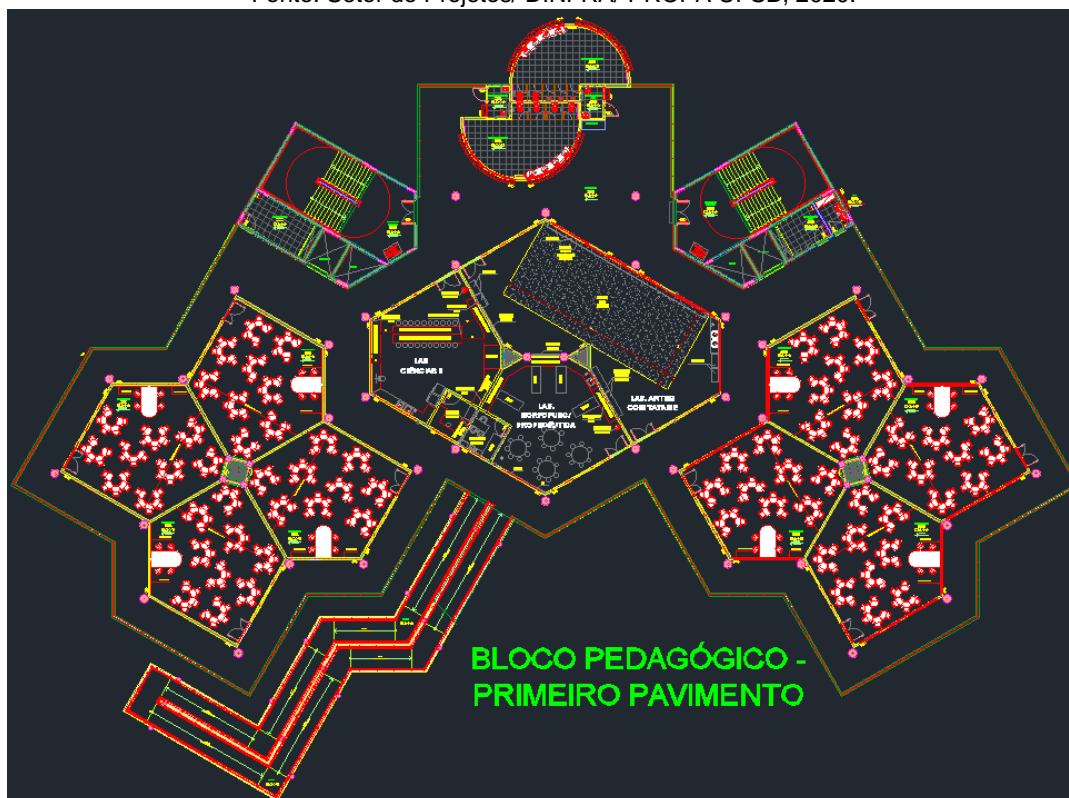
Planta Baixa do 1º pavimento do Núcleo Pedagógico CJA UFSB
